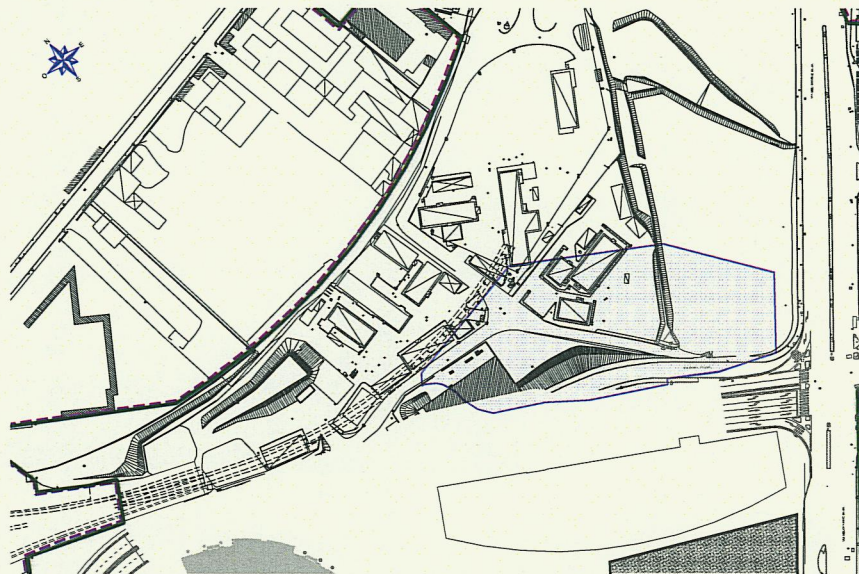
Rappresentazione del cantiere MODAM all'interno dell'area U3
